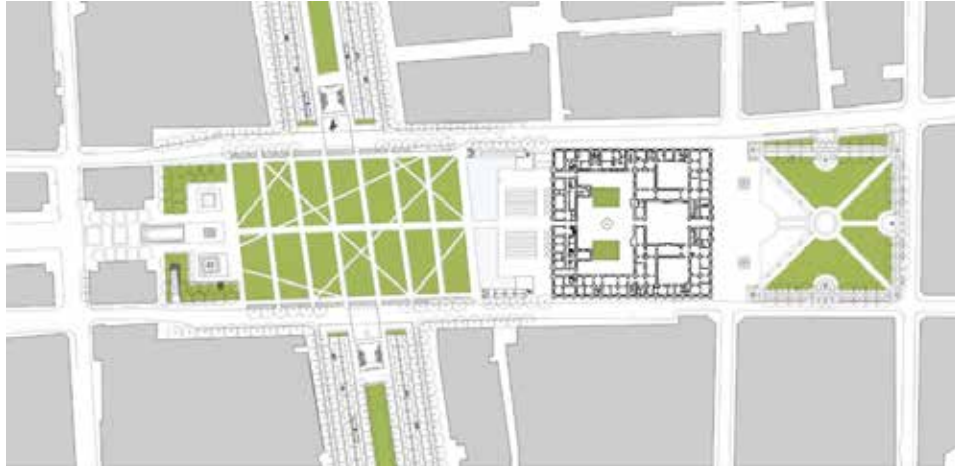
Planta de La Plaza de La Ciudadanía. Fuente: www.plataformaarquitectura.cl (2006)
